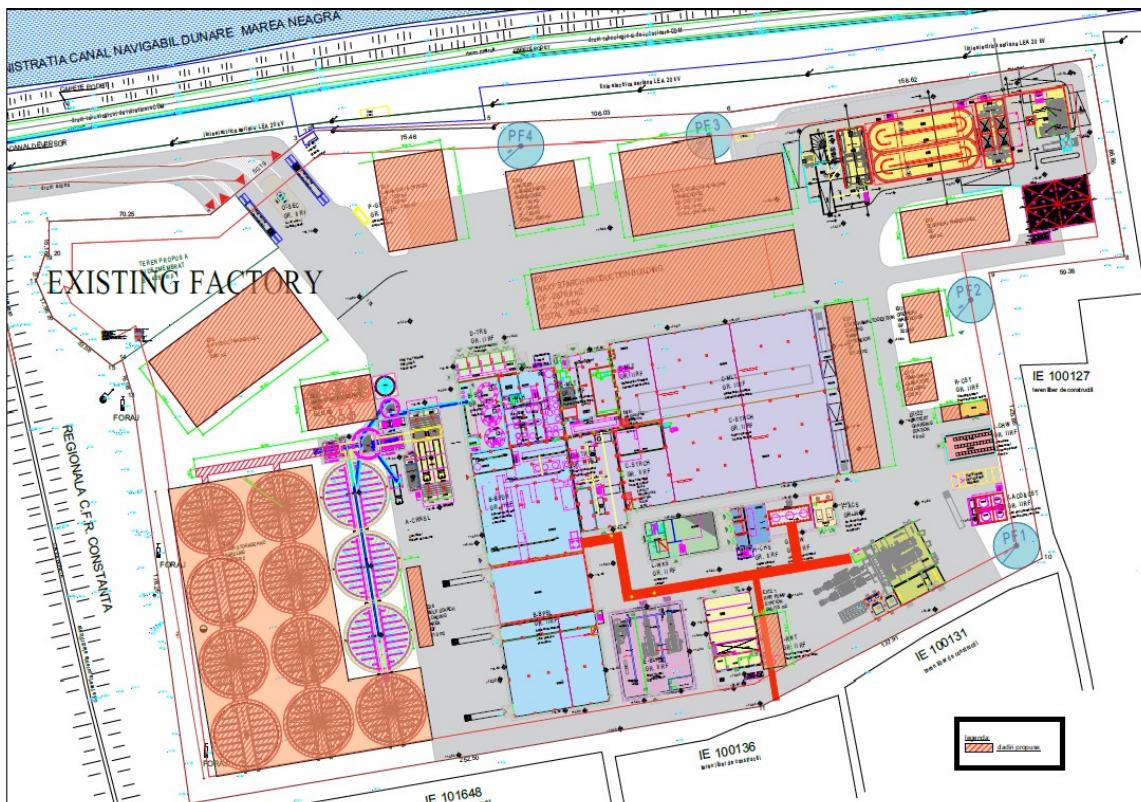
Planificare utilizare teren (constructii existente si constructii propuse)
